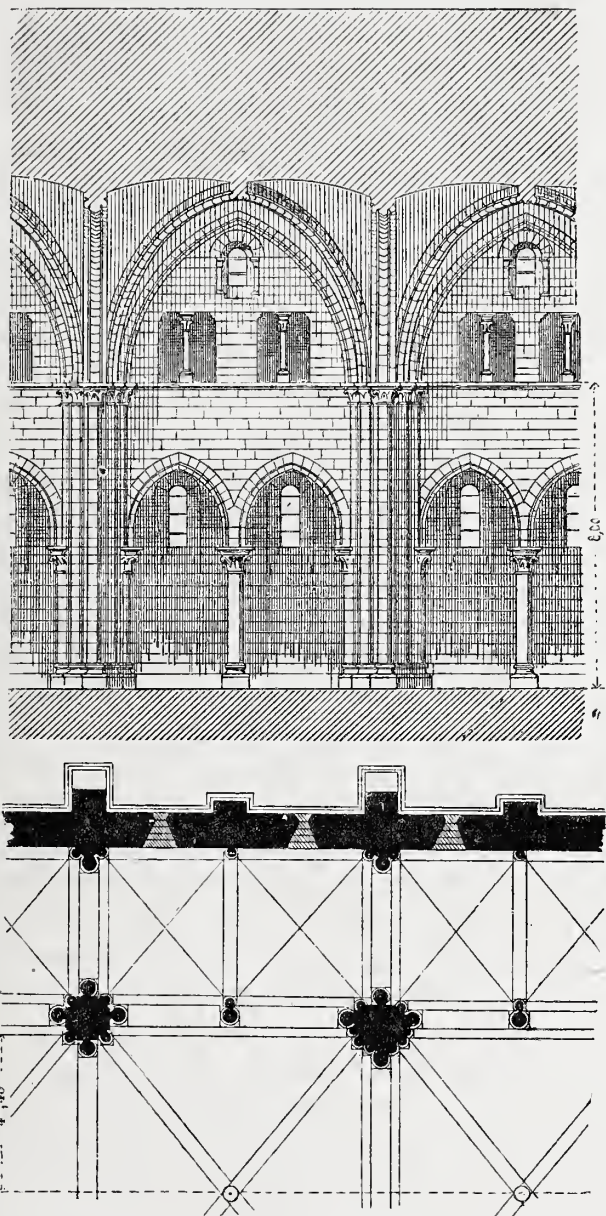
Coupe longitudinale sur la nef. — Élévation et plan. Échelle de 0,005 pour mètre.
